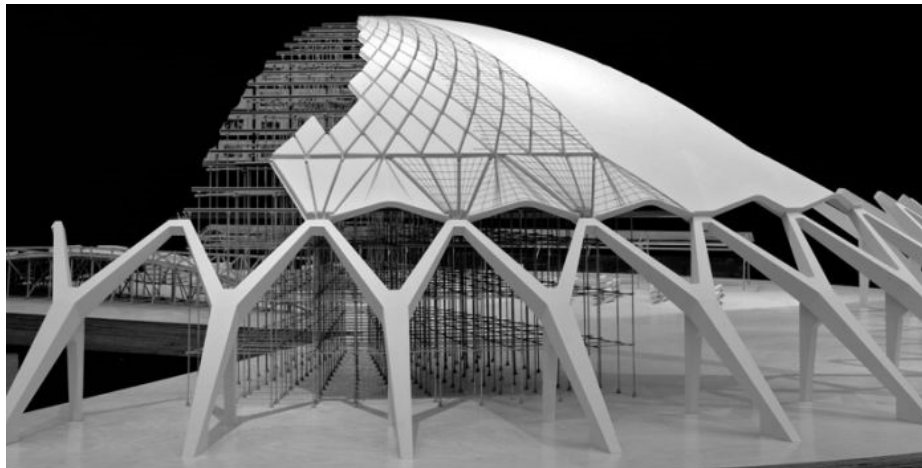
Processo construtivo do pavilhão dos desportos
